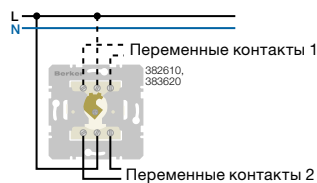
Выключатель/переключатель 1- и 2-полюсный для профильных полуцилиндров [№ для заказа 3826 10, 3836 20]
